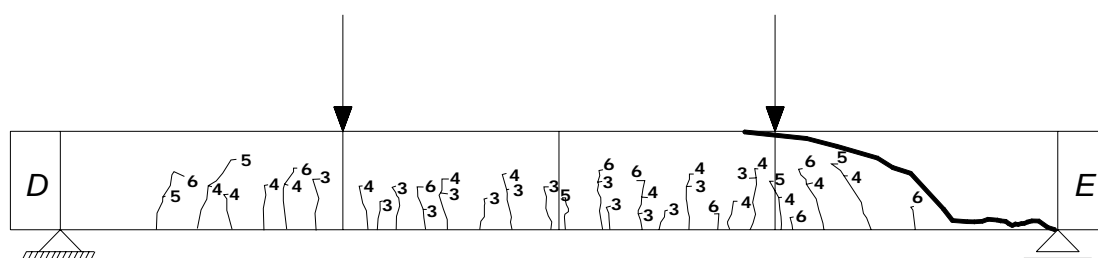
Padrão de fissuração para a viga V50-1 sem armadura transversal
